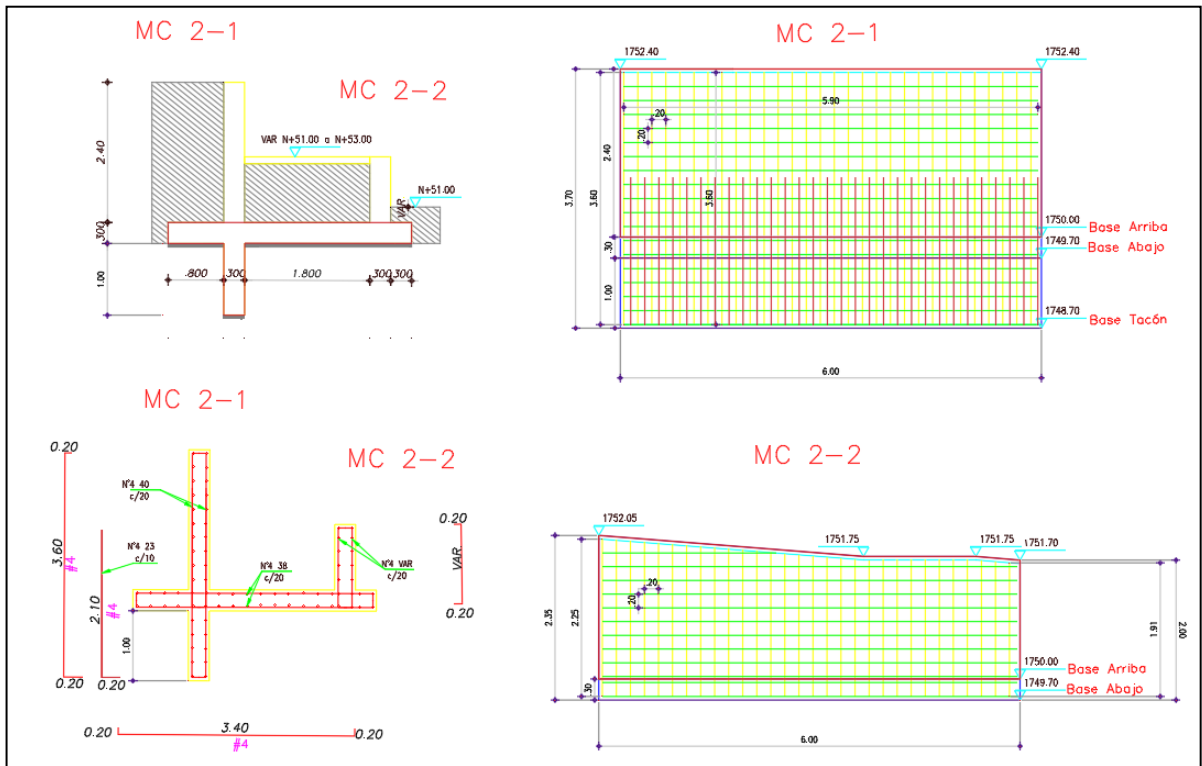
Perfil longitudinal y corte transversal Muro contención MC-2.
